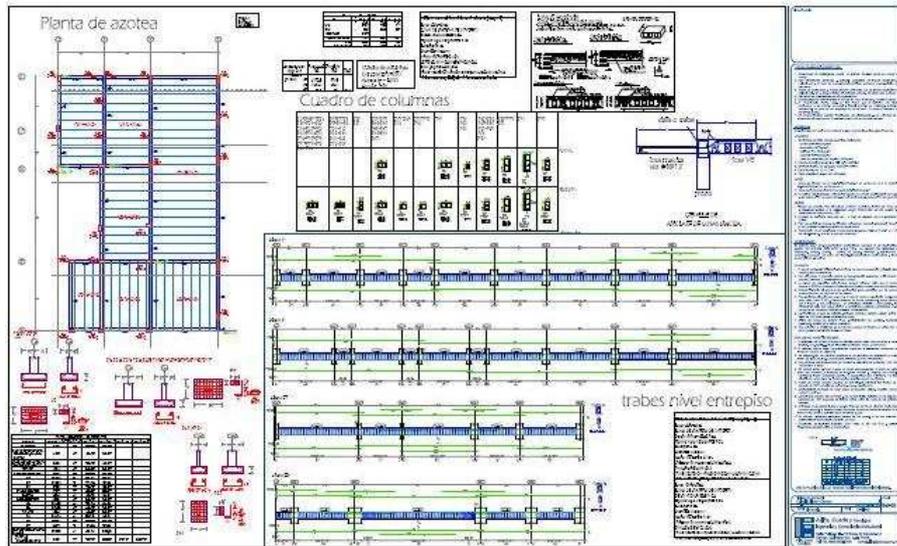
Ejemplo de plano estructural: detalles de losa, columnas y trabes tipo.
